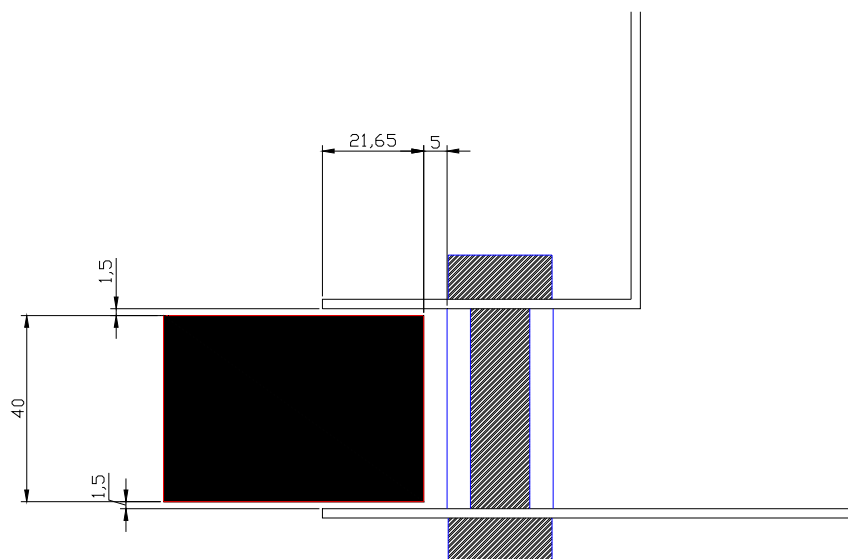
Vista superior del encastre de paneles en viga metálica
